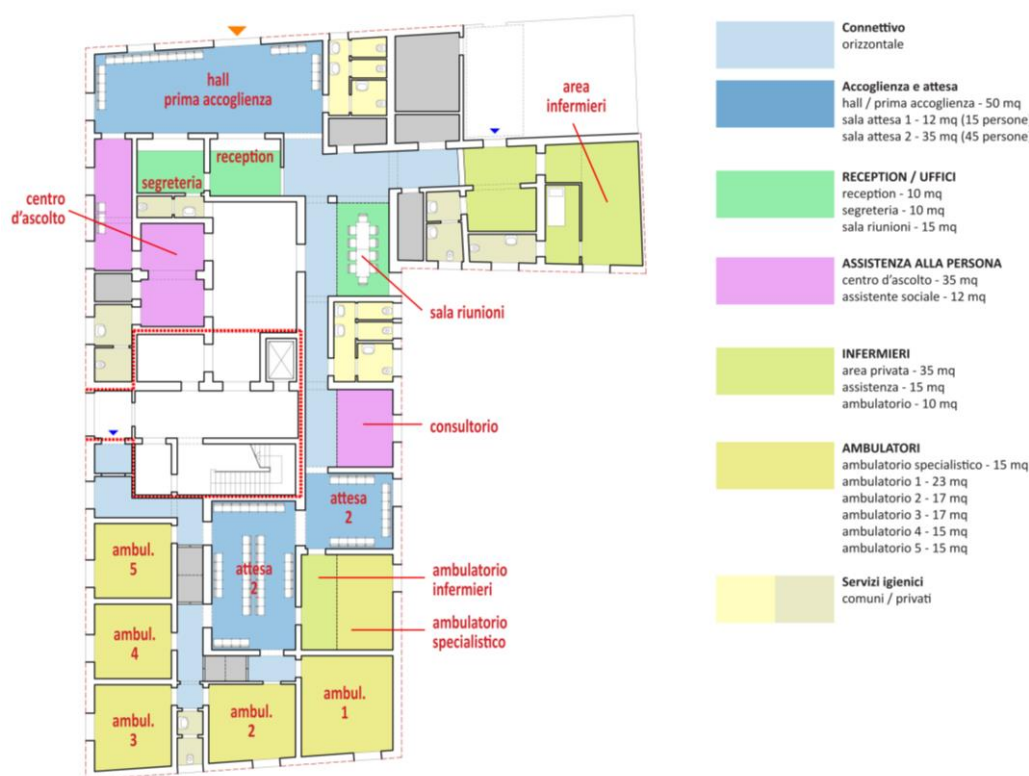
PIANTA PIANO TERRA / STATO DI PROGETTO “CASA DELLA SALUTE” (S01)
